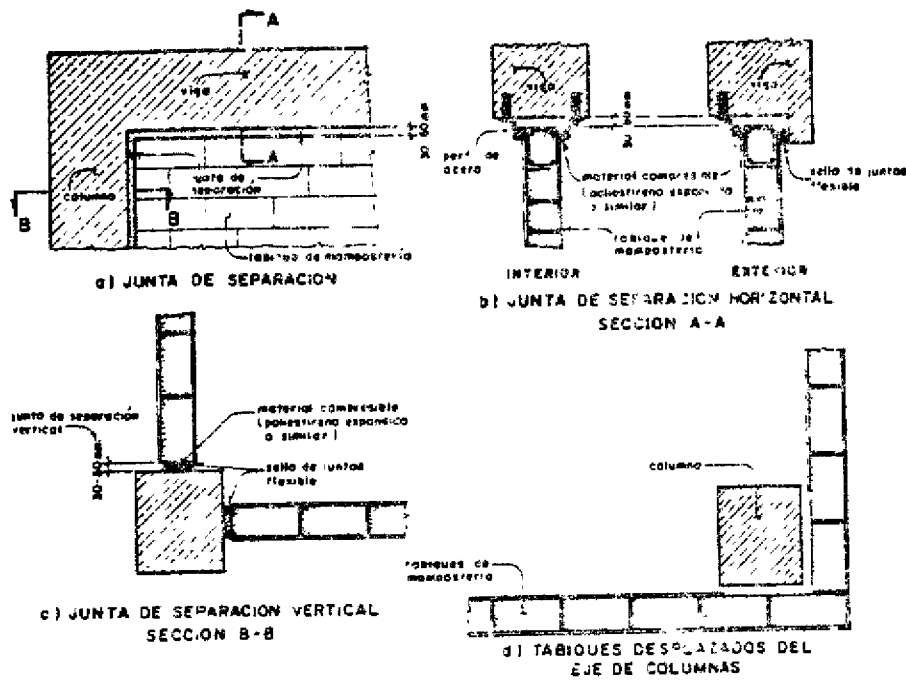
Detalles constructivos tendientes a separar los elementos de mampostería de la estructura - a.,b. y c.) Juntas de separación verticales y horizontales - d.) Tabiques desplazados del eje de las columnas.
